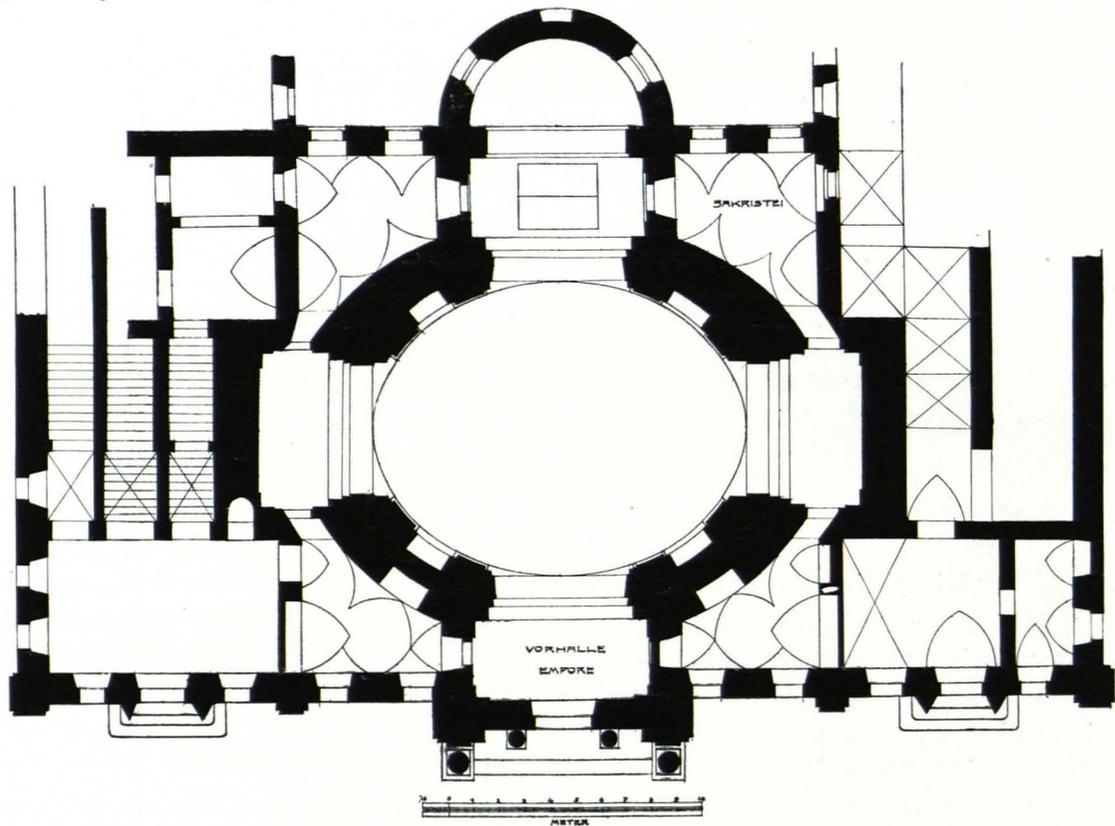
Kajetankirche, Grundriß 1 : 300 (S. 113)
